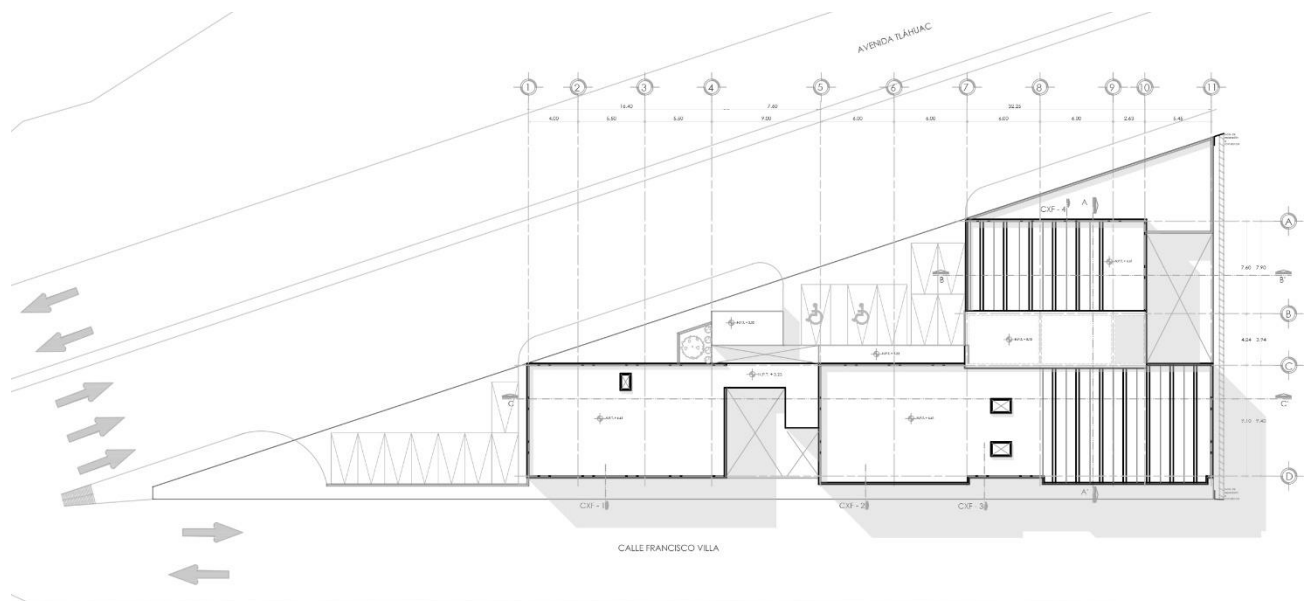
Plano de conjunto sin escala, fuente: elaboración propia.
